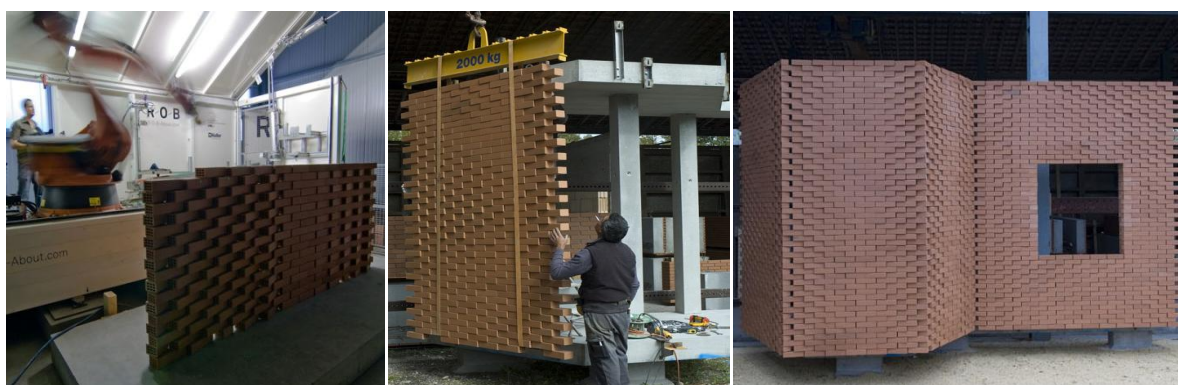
Uso da robótica na construção de uma parede prefabricada de alvenaria. [22]
